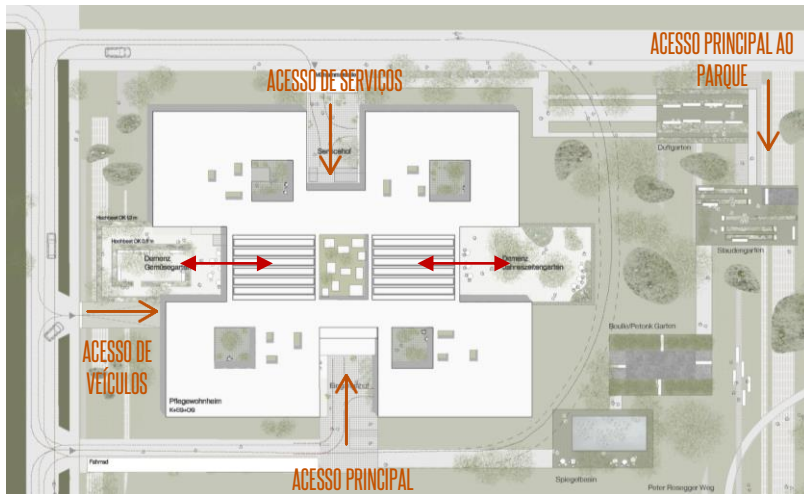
Planta de situação com esquema de acessos. Fonte: ArchDaily. Esquema elaborado pela autora. 2020.
